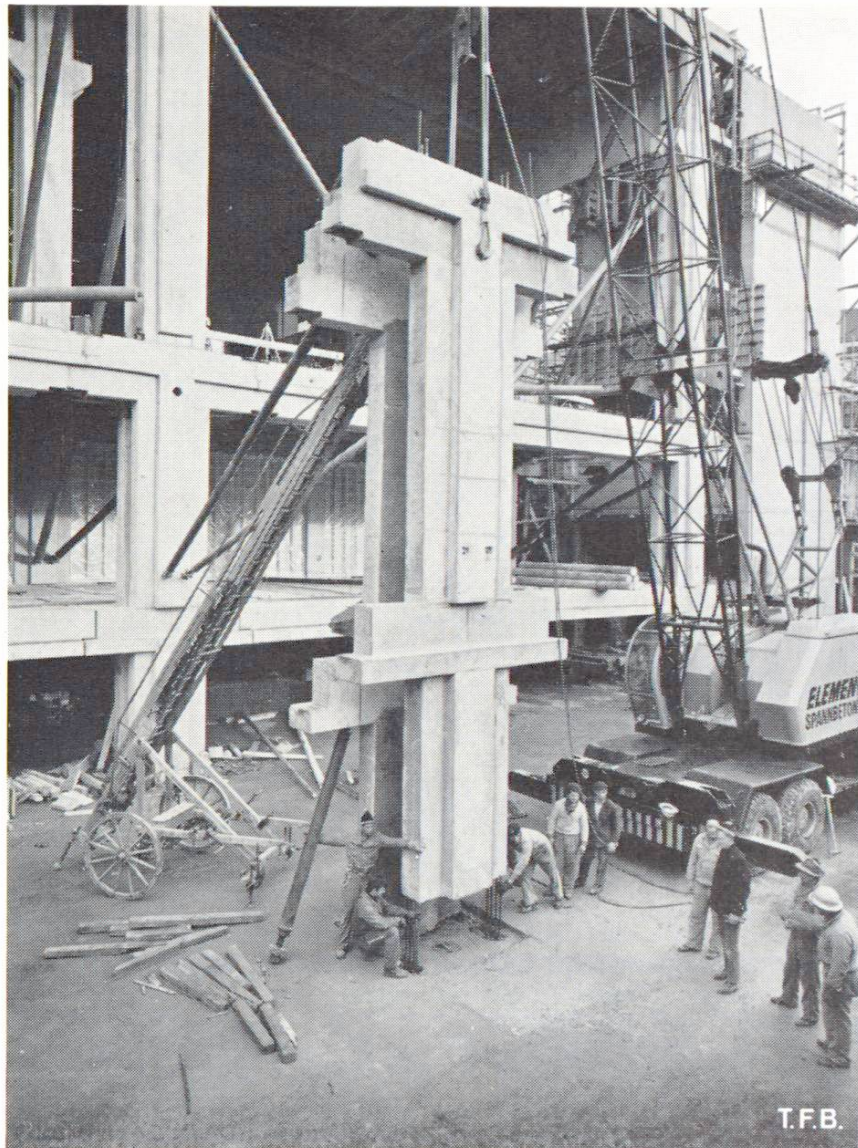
Pose d'un pilier de cave. Les fers de liaison sont introduits dans des trous de la fondation ménagés à cet effet. La position exacte du pilier est déterminée par une plaque d'appui avec un boulon. Ce pilier supportera une charge de 740 t.
